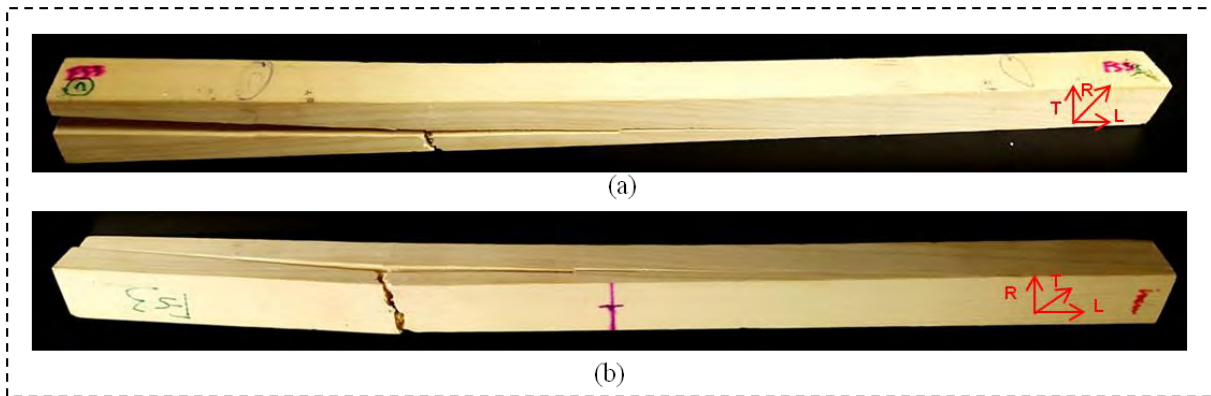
Faciès de rupture de l'éprouvette FS3 (a) face avant LT (b) face tendue LR
